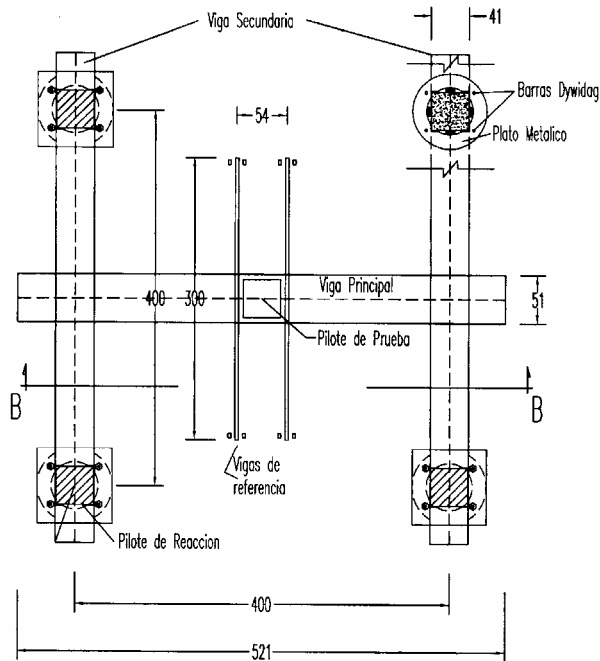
Arreglo en planta del pilote de prueba y los pilotes de reacción (acotamientos en cm)
